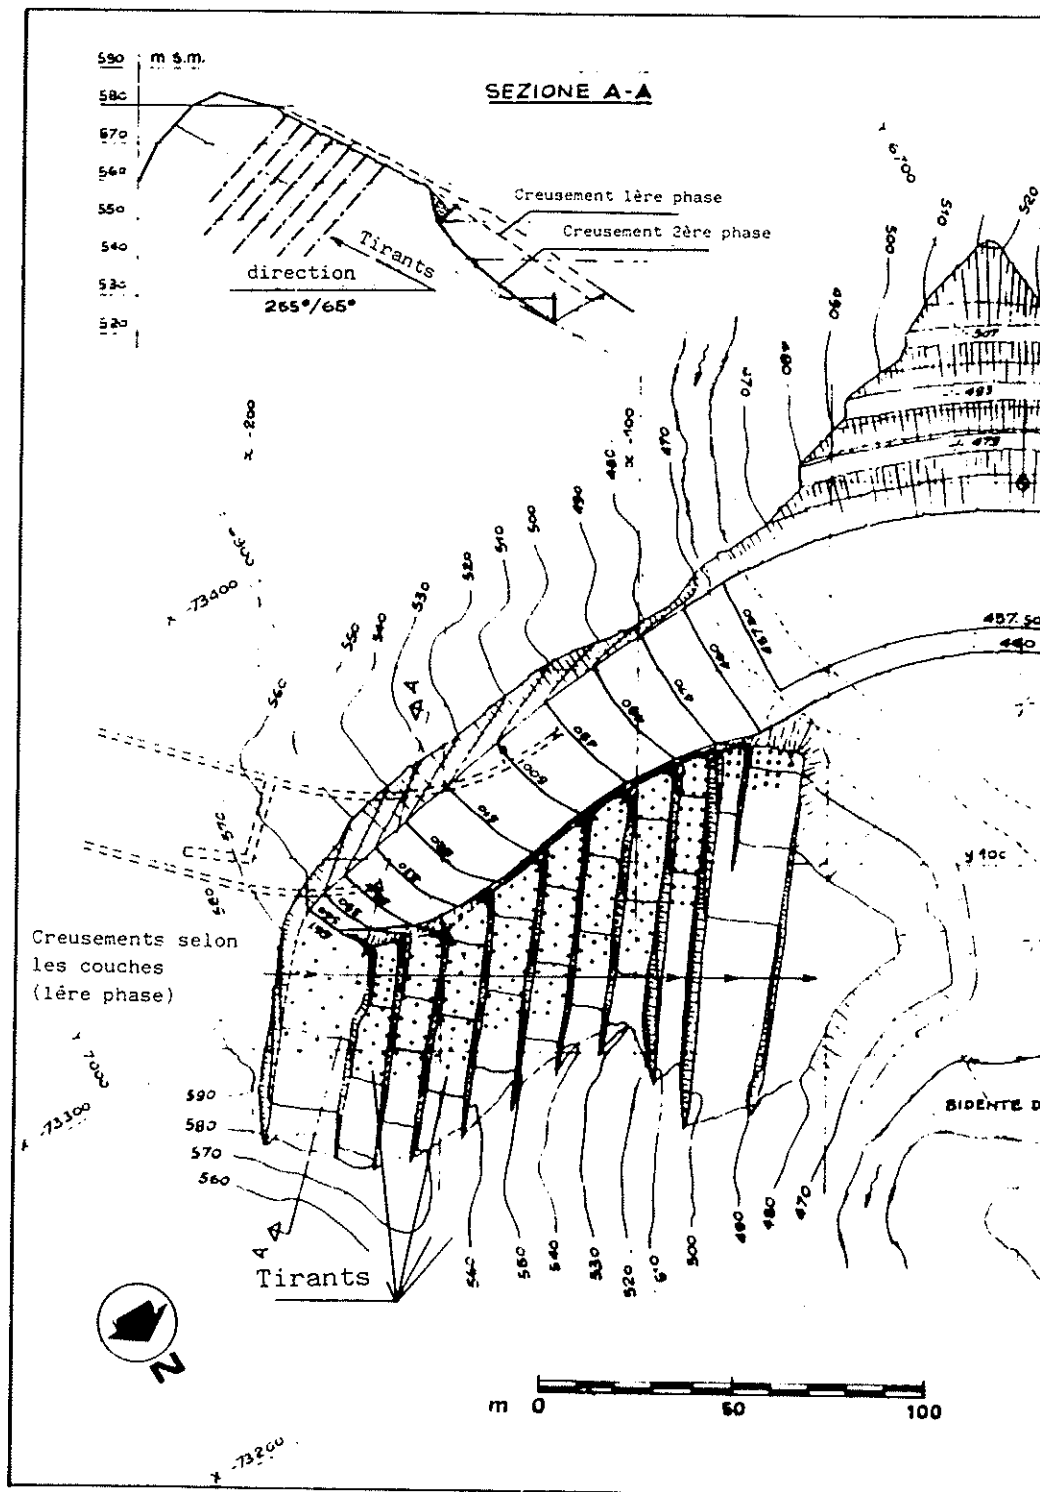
Planimétrie des excavations d'appui dans la rive droite
